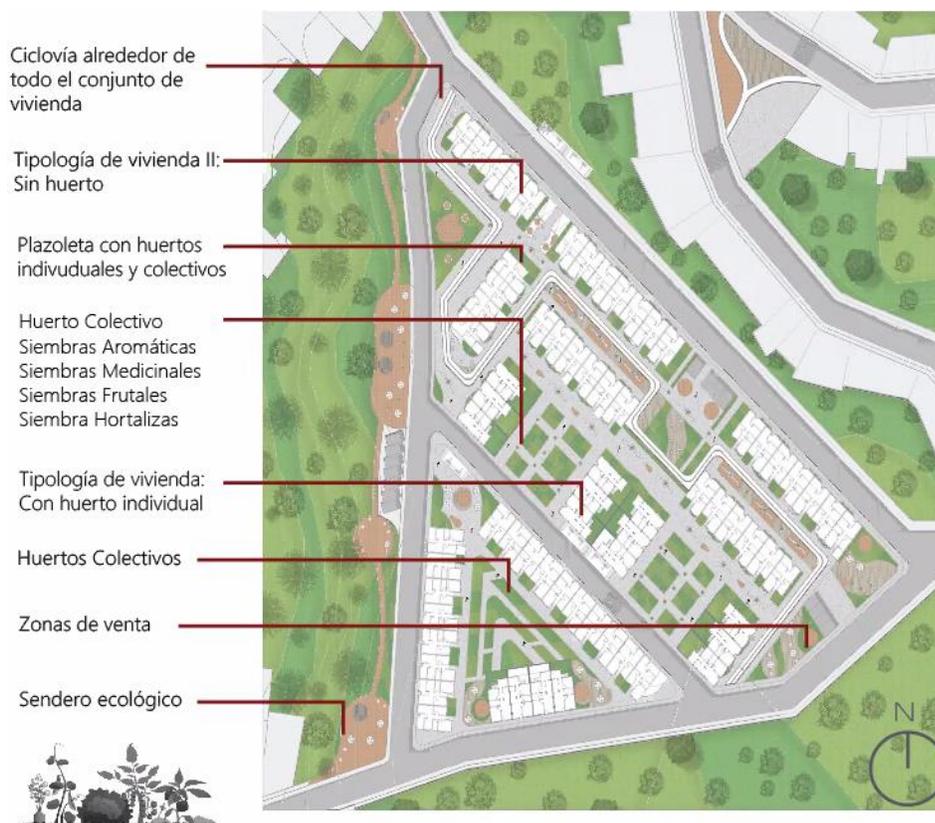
Implantación de vivienda. Elaboración propia con AutoCAD
